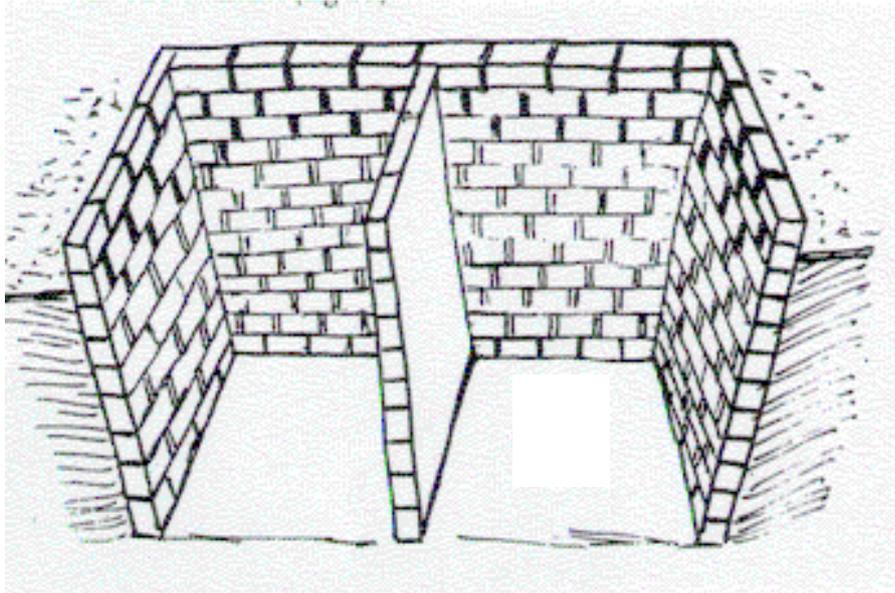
construction de la fosse en cas de terrain instable (murs montés sur toute la hauteur de la fosse). Nota : le chaînage n'apparaît pas sur la figure.
